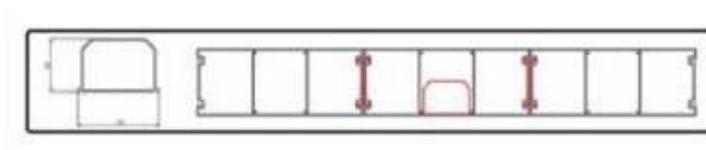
Esquema em planta do perfil canaleta dentro do módulo básico
